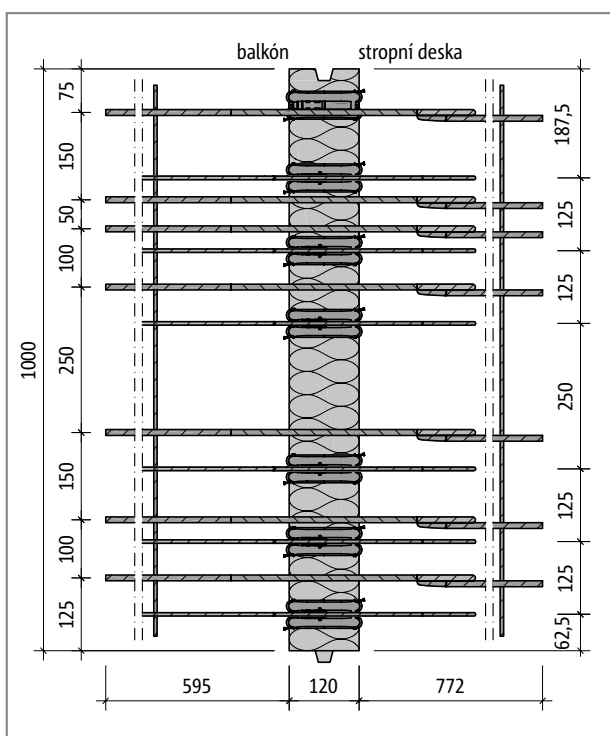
Schöck Isokorb® typ KXT30-HV15: Řez prvkem
